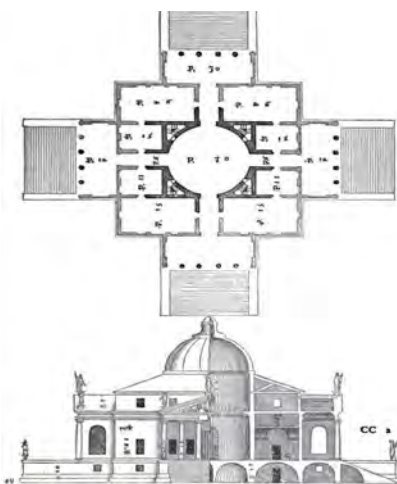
Andrea Palladio, Villa La Rotonda, Grundriss und Aufriss
